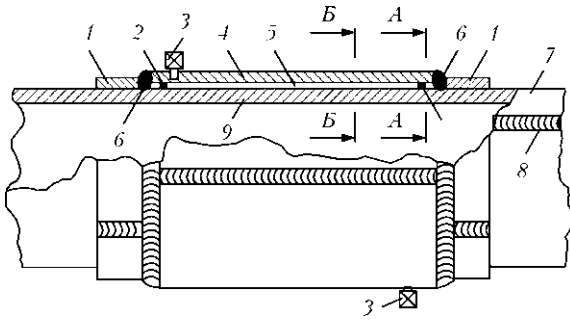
Схема способа ремонта с помощью герметичной муфты с наполнителем [3]: 1 — технологические кольца; 2 — тонкостенное дополнительное кольцо; 3 — штуцер; 4 — муфта; 5 — наполнитель; 6 — кольцевые сварные швы; 7 — трубопровод; 8 — продольный шов; 9 — дефектный участок
